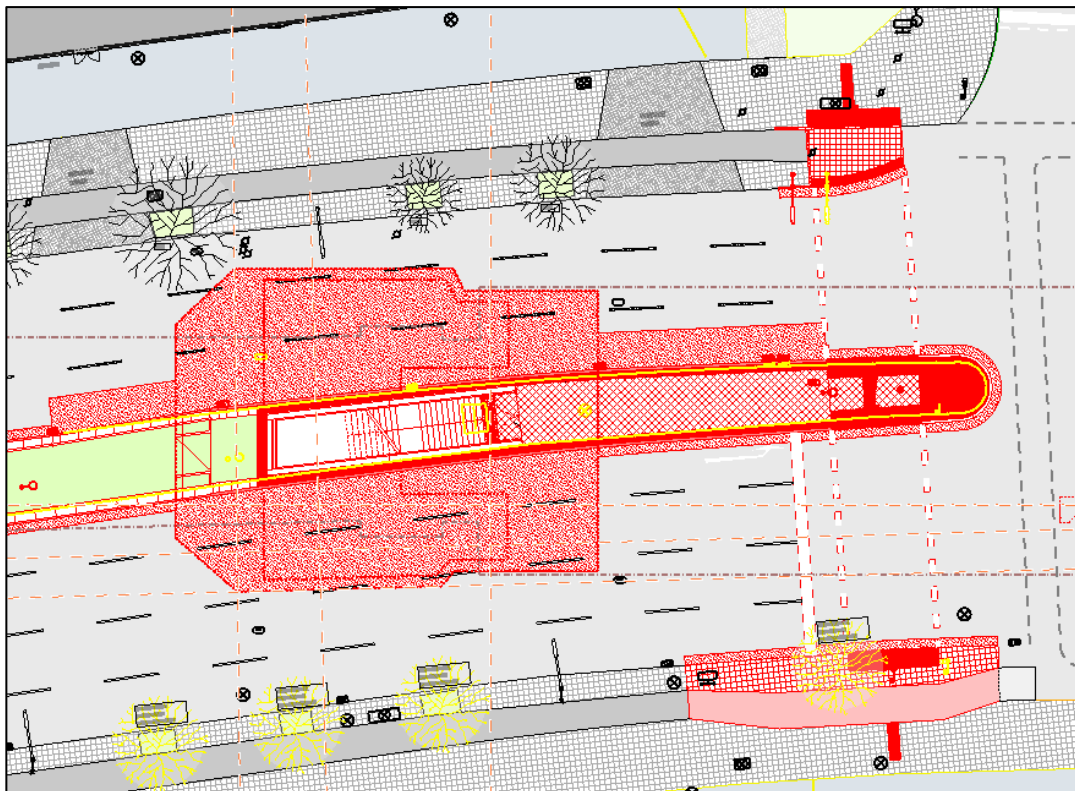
Ausschnitt Plan Zi\_PG 2.1a Entwurf Straßenebene (unmaßstäblich)
